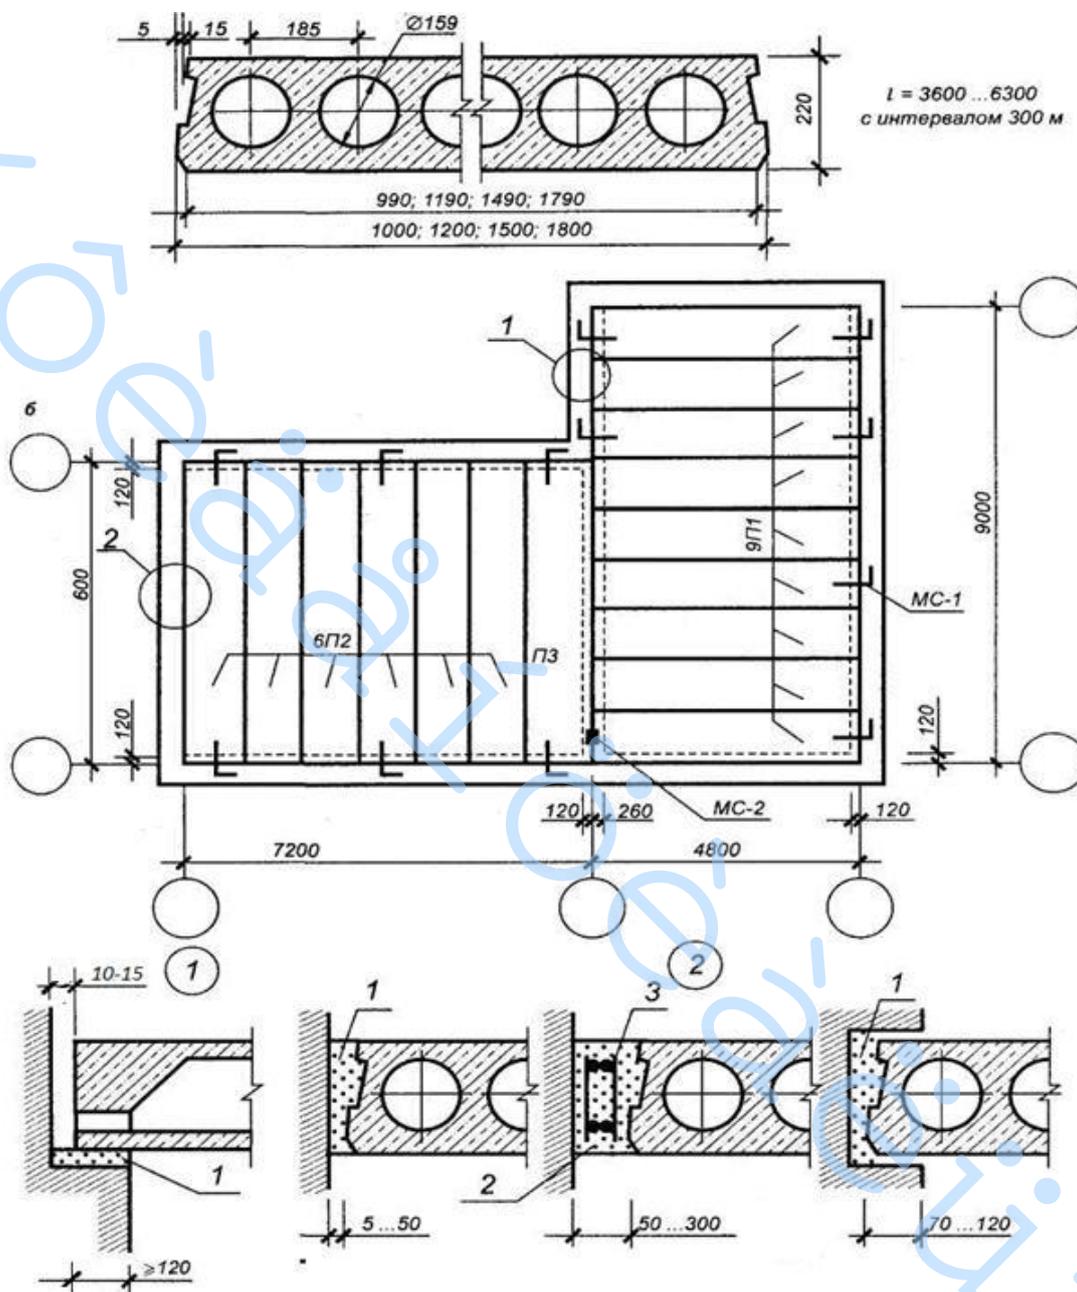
Схема раскладки ж/б плит типа ПК и узлы опирания на стены и примыкания к ним с замоноличиванием зазора или устройством монолитных участков: 1 – узел опирания плиты на несущую стену; 2 – узел примыкания плиты к самонесущей стене; в узлах: 1 – цементно-песчаный раствор; 2 – монолитный участок; 3 – металлический каркас
